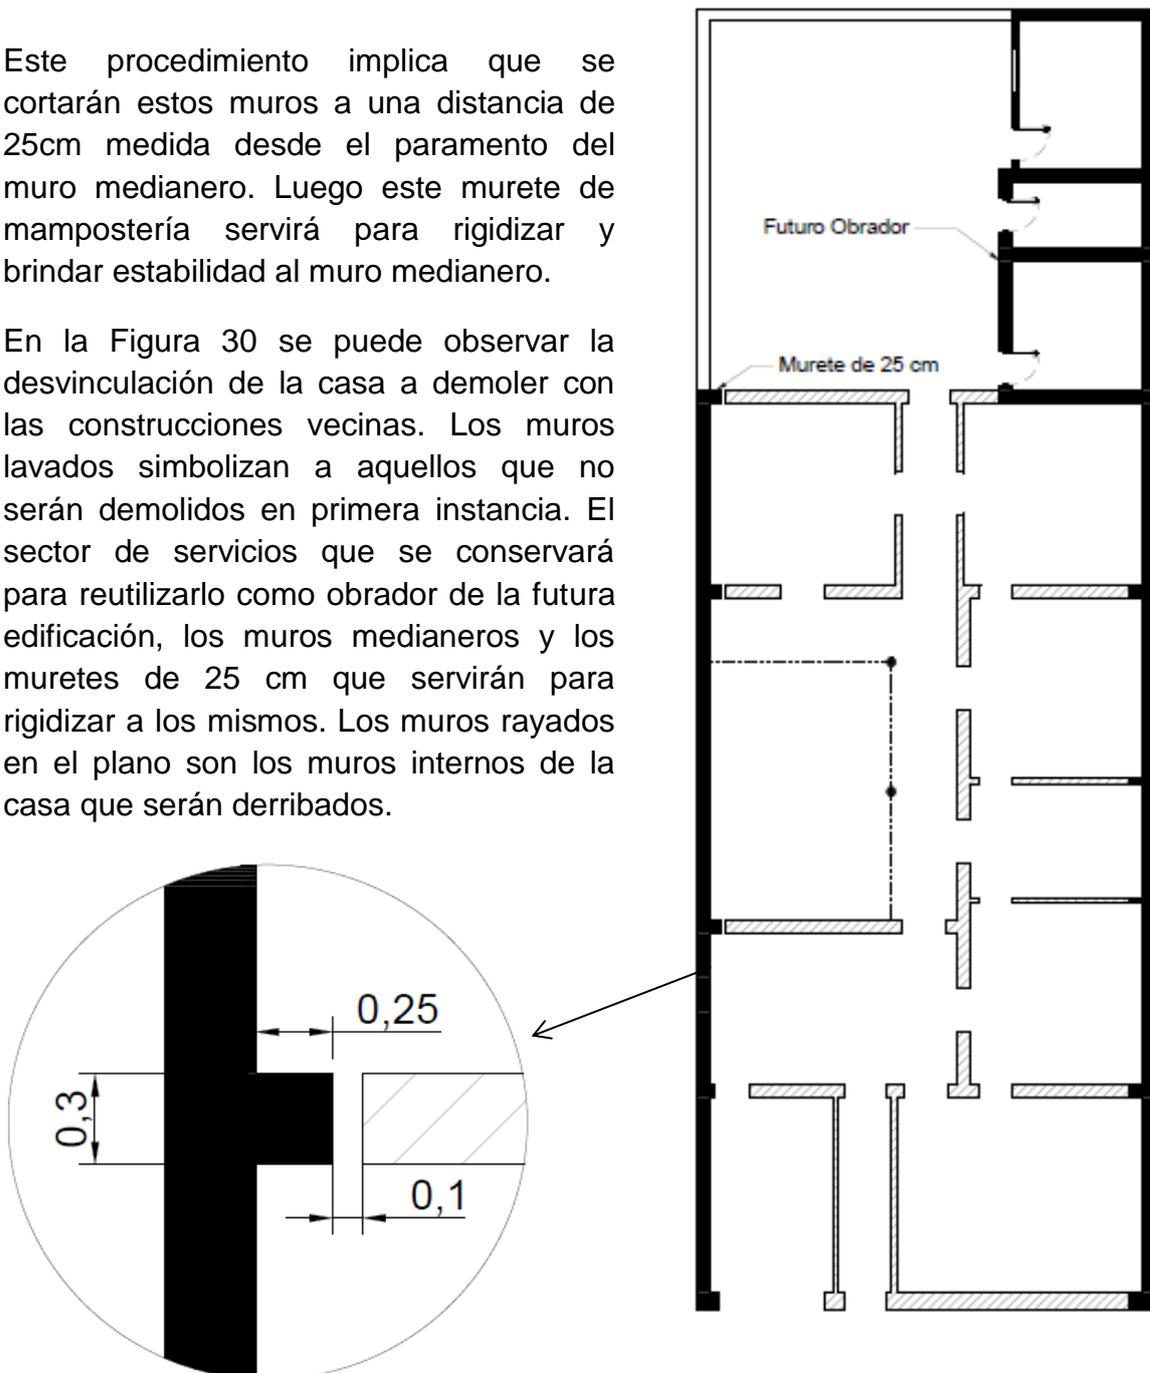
Desvinculación de construcciones vecinas - Detalle de murete de 25 cm.
